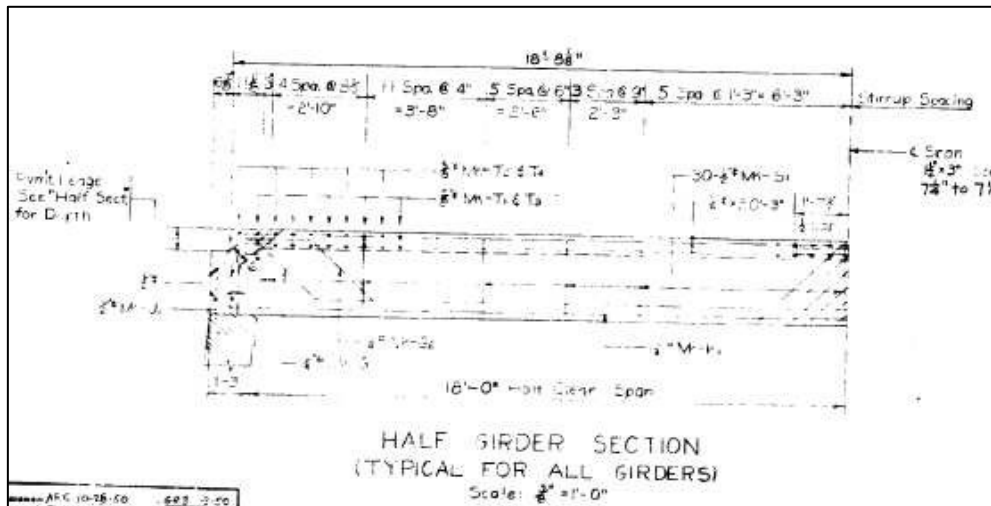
Detalle refuerzo en zona media de la viga puente No 1
